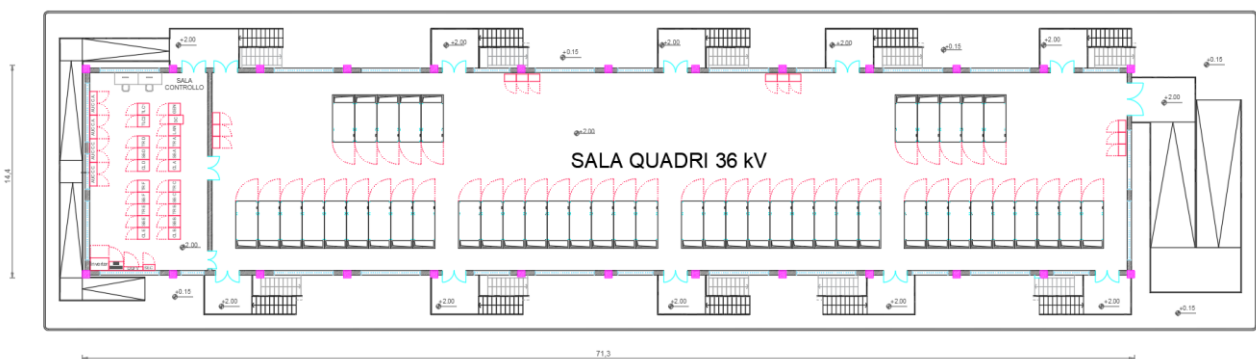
Planimetria tipologia edificio quadri 36 kV
